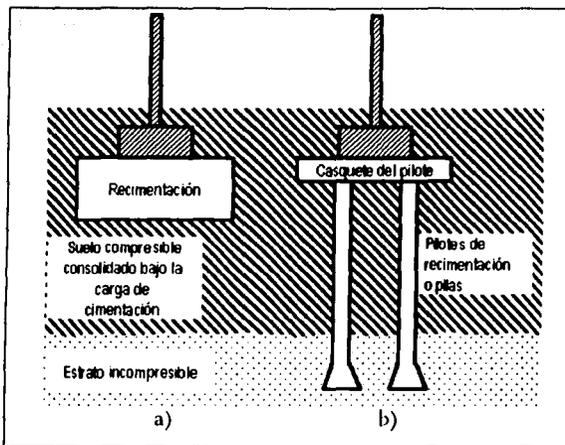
Recimentación para detener el asentamiento debido a la consolidación del suelo bajo la carga de la cimentación
